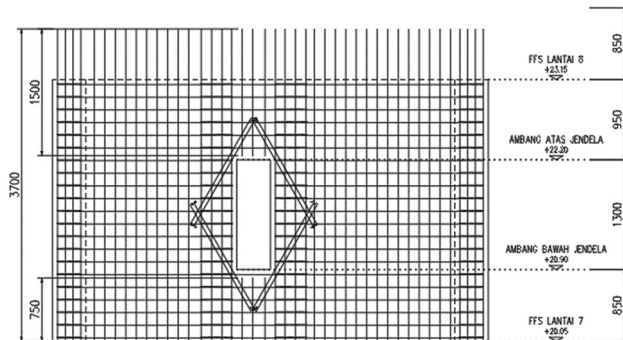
22: (a) Detail Penulangan *Shearwall*,
